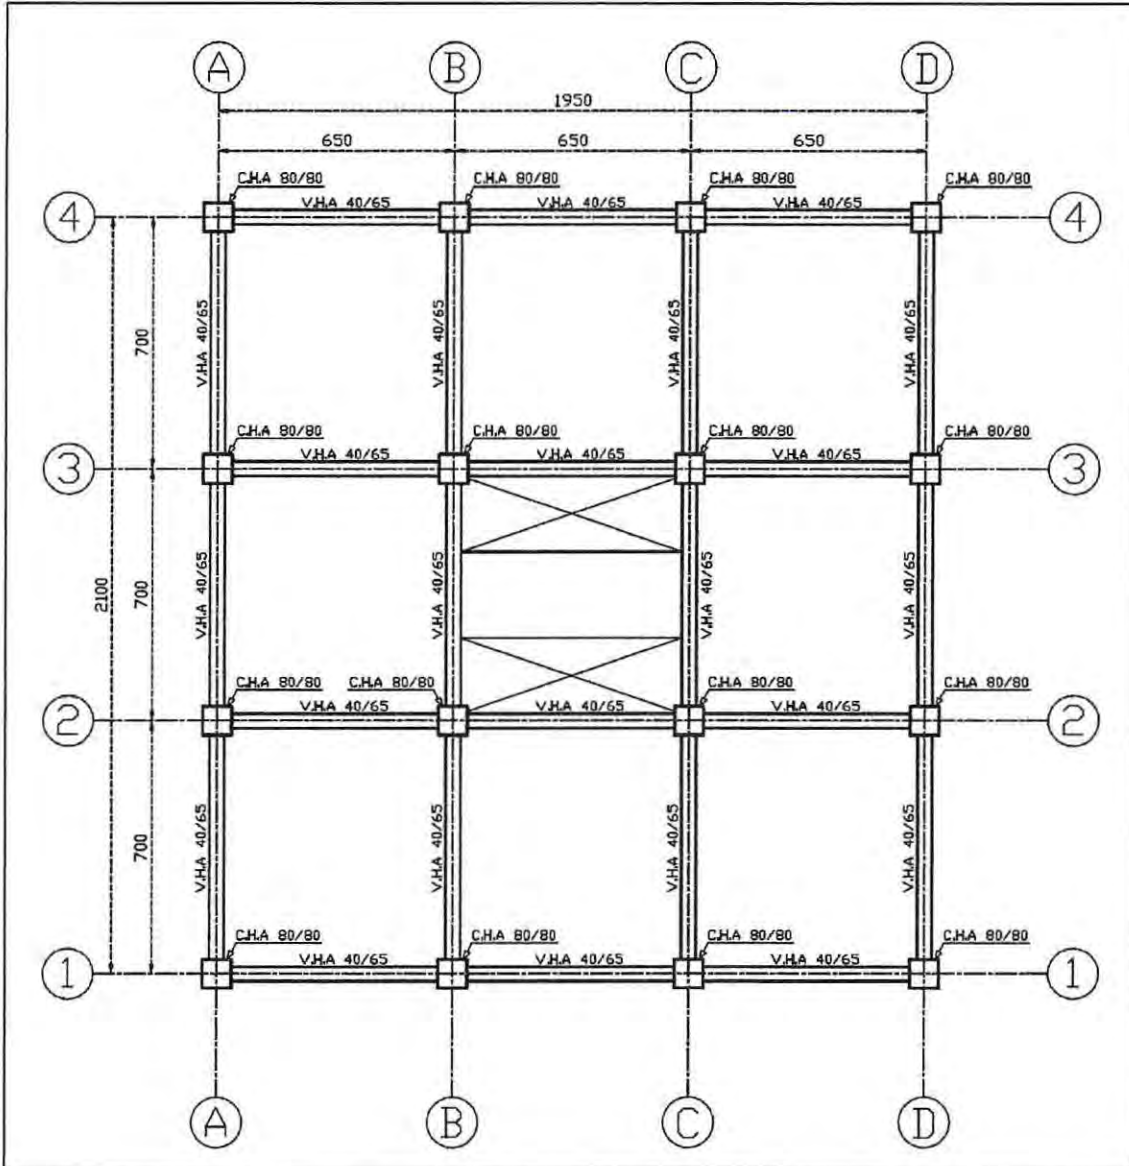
Planta tipo - Edificio estructurado con marcos.
